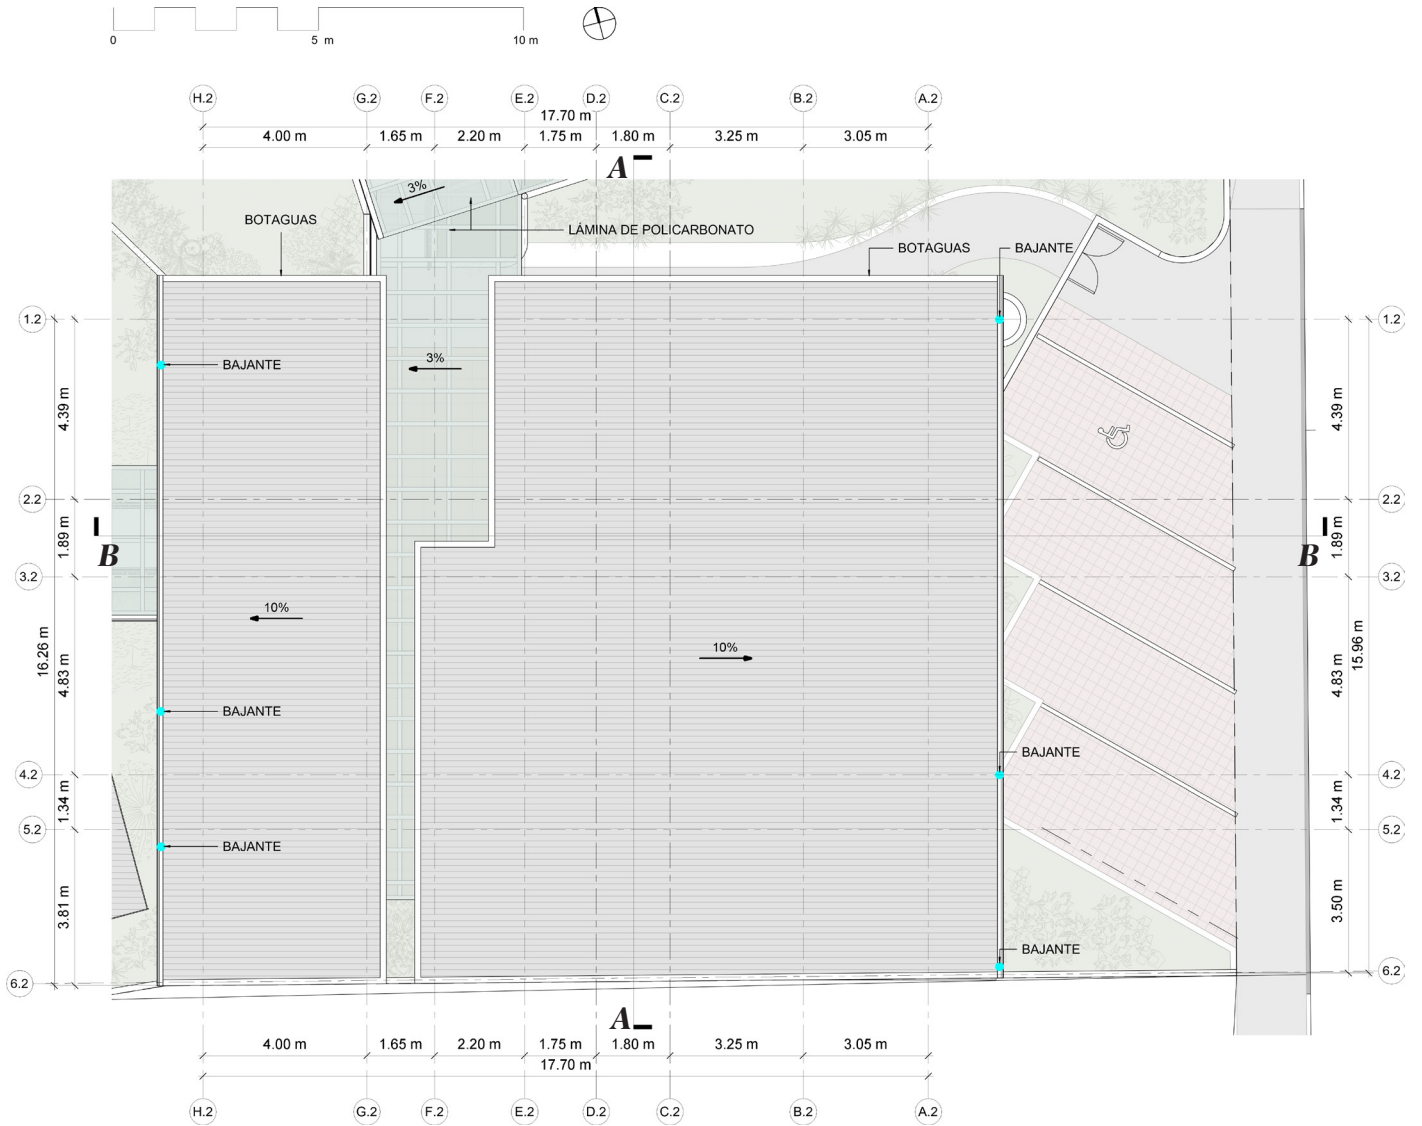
Planta de Cubiertas de Volumen 2. Fuente: Elaboración propia
